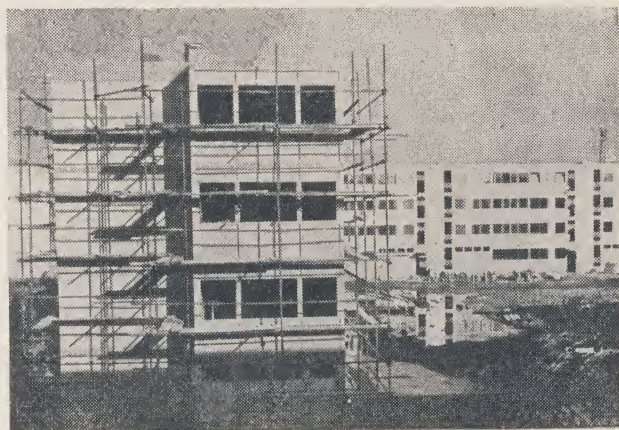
Laka drvena skela za montažu stropa i betoniranje serklaže.
